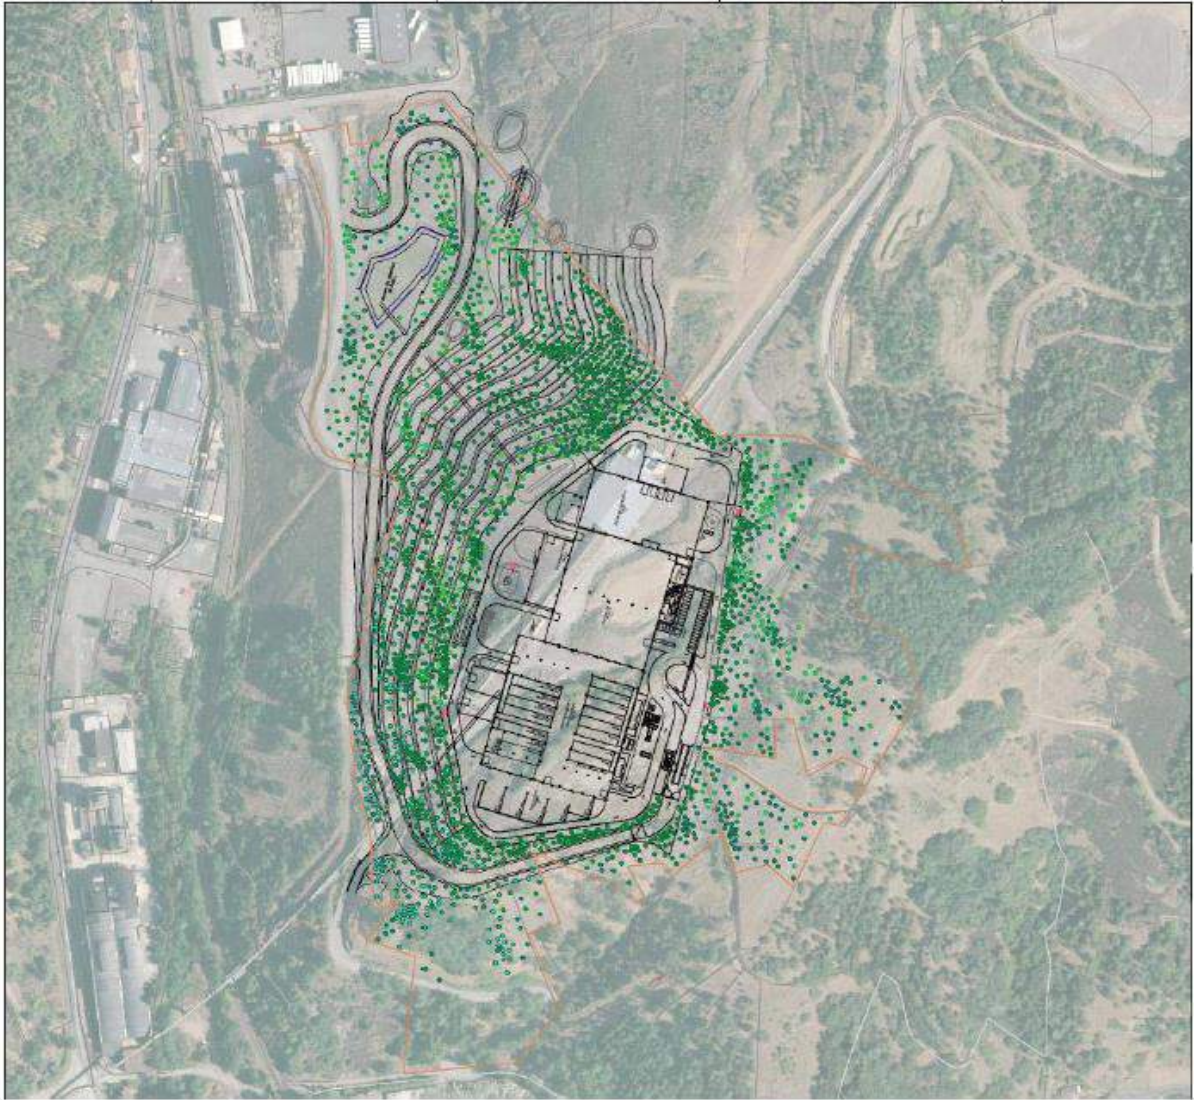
EXTRAIT DU PLAN DE REAMENAGEMENT (PLANTATIONS) DE DUNET
